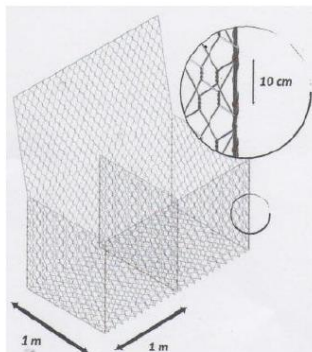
Amarrado de las aristas del gavión. Fuente: (ACEROS METALES Y MALLAS LTDA, 2016)
